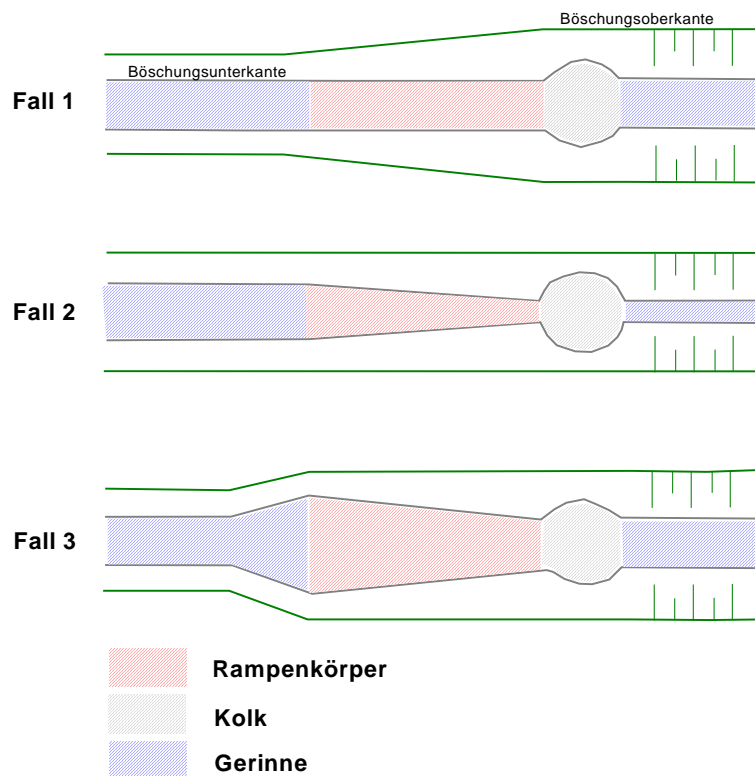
Mögliche Grundrissformen für eine geschlossene, klassische Rampe
